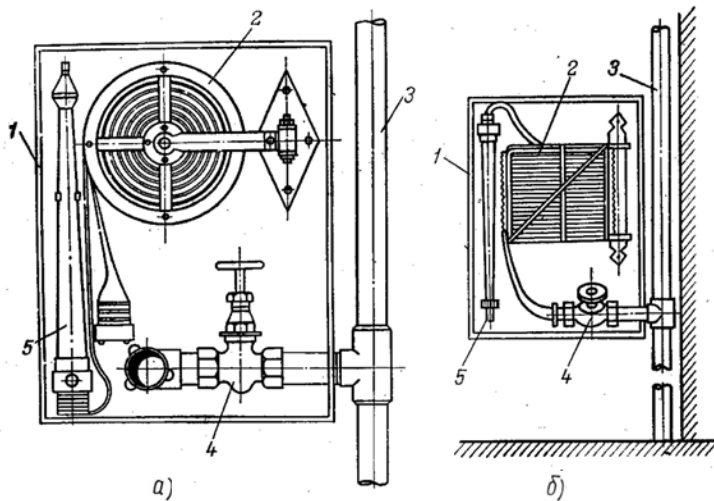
Схема размещения пожарного крана на внутреннем пожарном водопроводе [11]:
